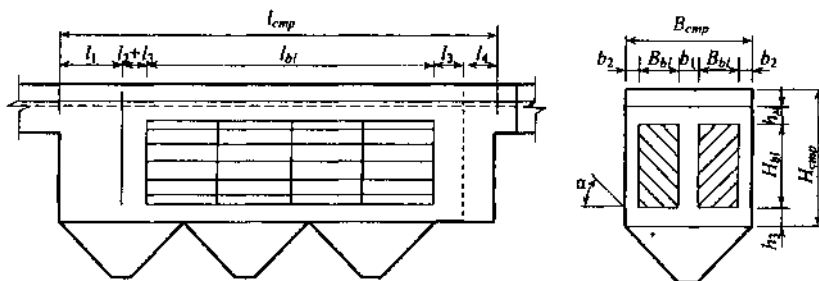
Расчетная схема тонкослойного отстойника с перекрестной схемой работы
